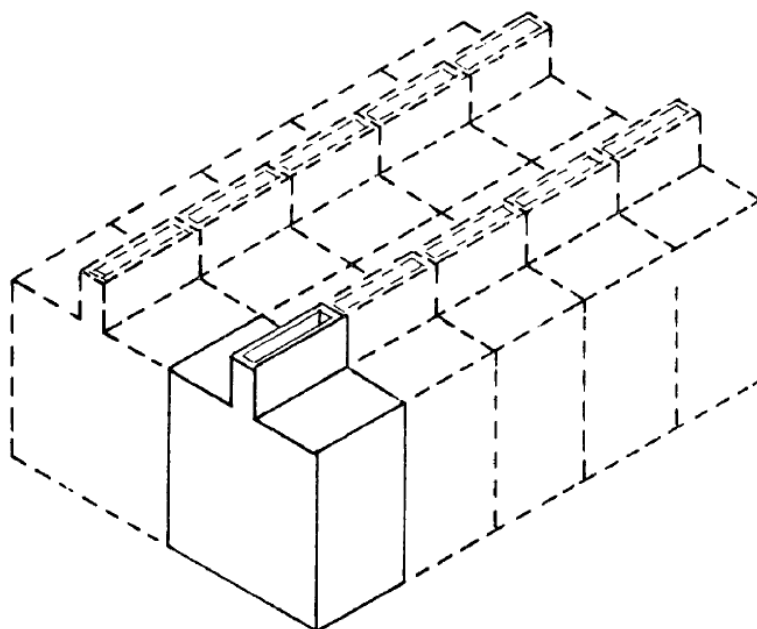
Устройство щелевых резонаторов Гельмгольца из одиночных резонаторов.
